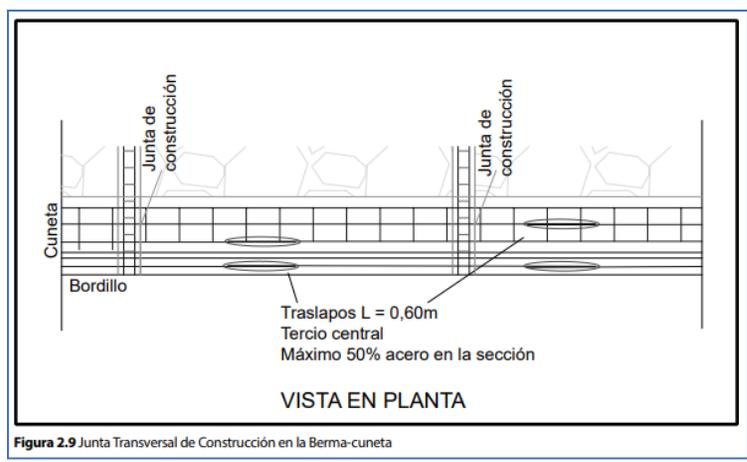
Junta Transversal de Construcción en la Berma-cuneta
